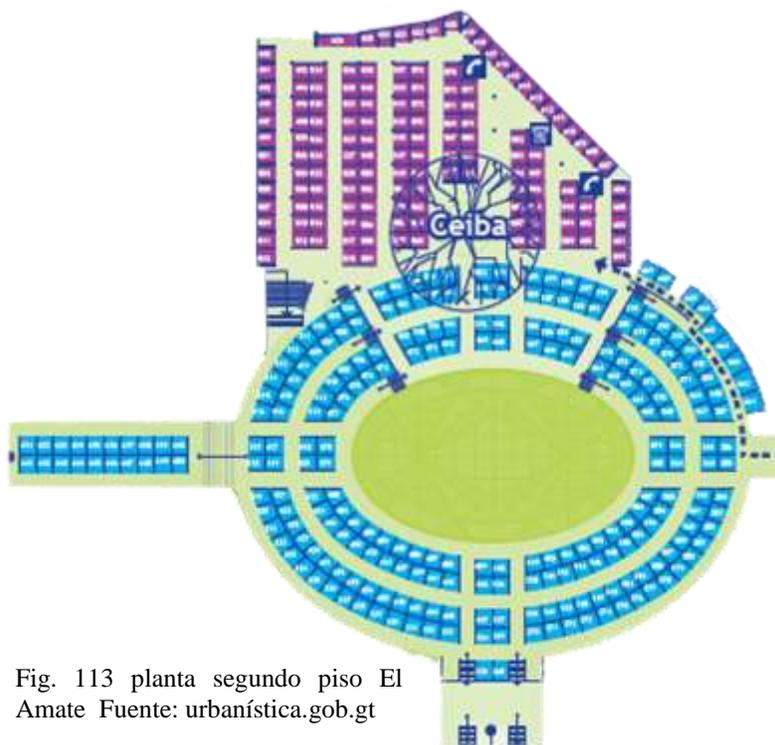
planta segundo piso El Amate Fuente: urbanística.gob.gt
